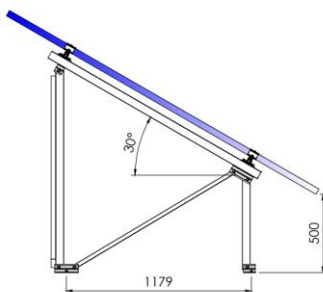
Dimensiones estructura de soporte. Fuente: Sunfer
